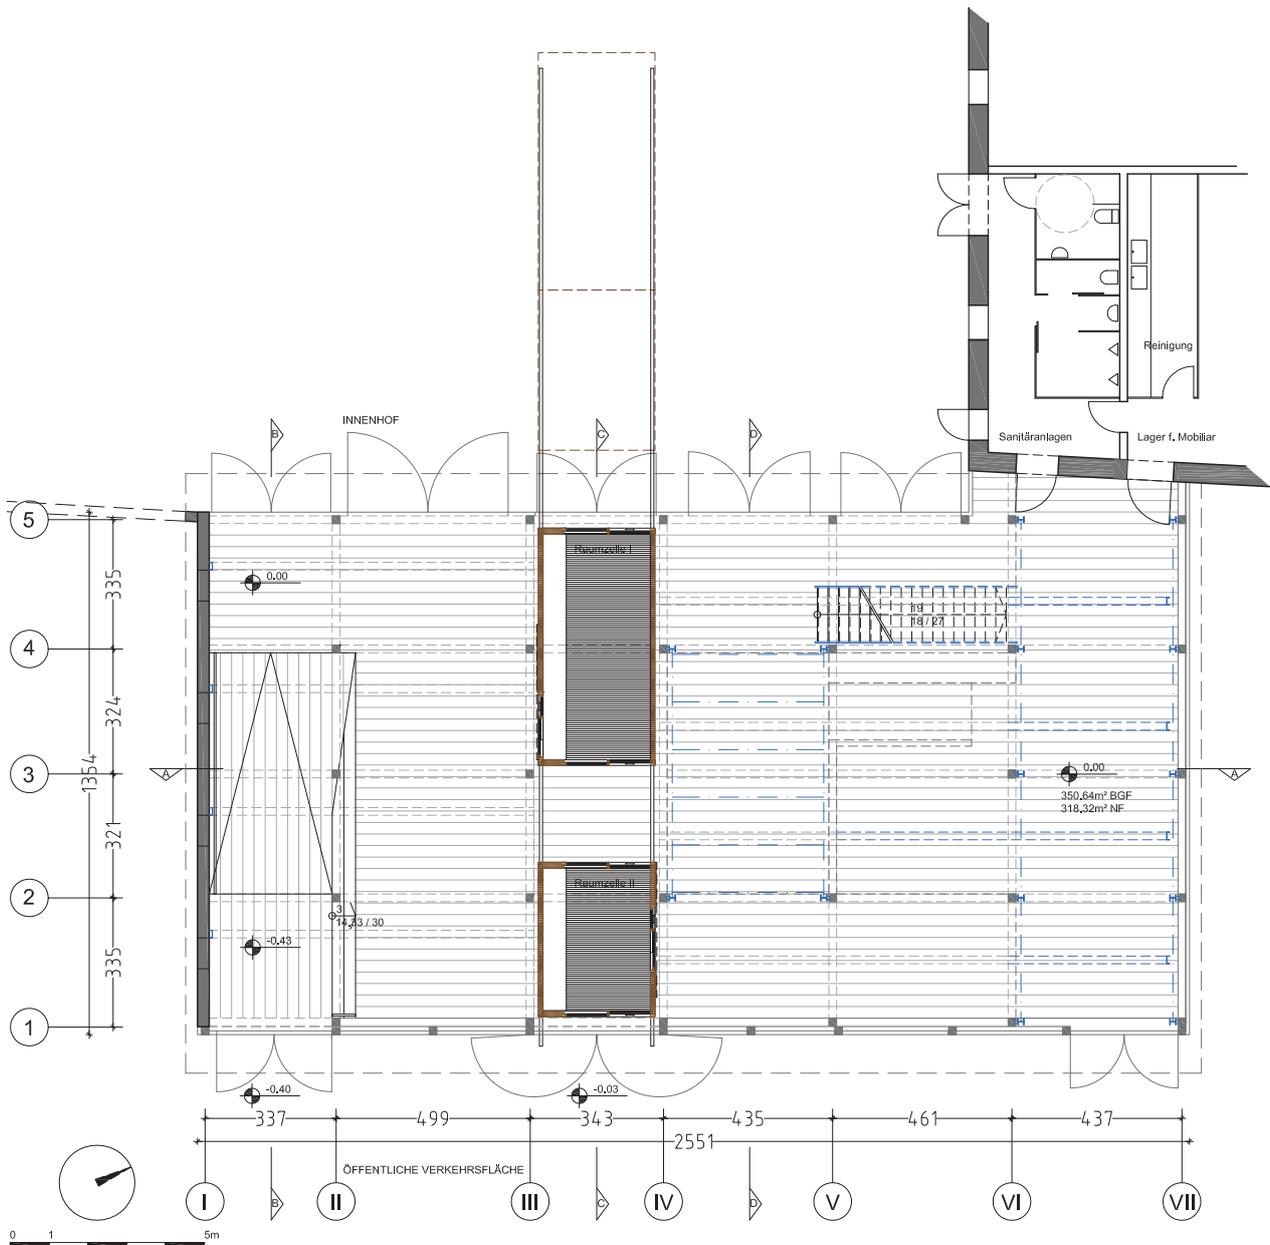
, Grundriss Ebene 0.00 M 1 : 200
